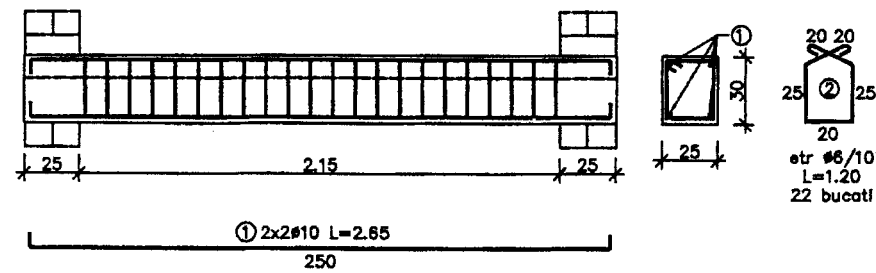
Plan cofraj și armare grindă de podest – 2 bucăți
